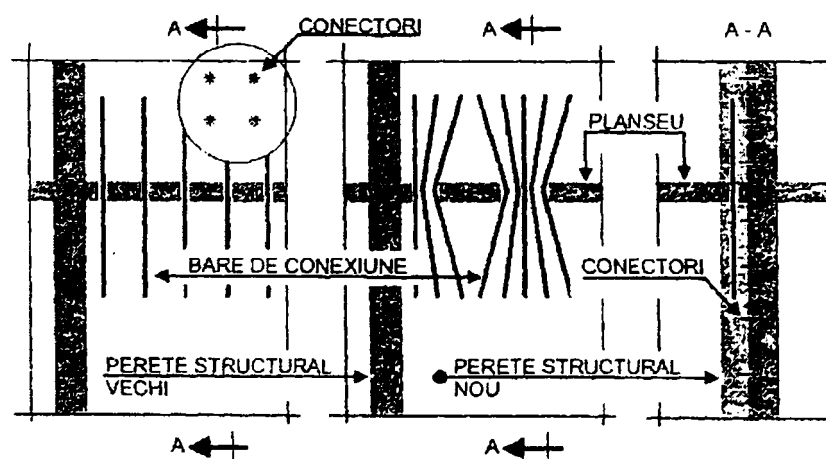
Consolidarea pereților structurali din beton armat cu pereți noi.
